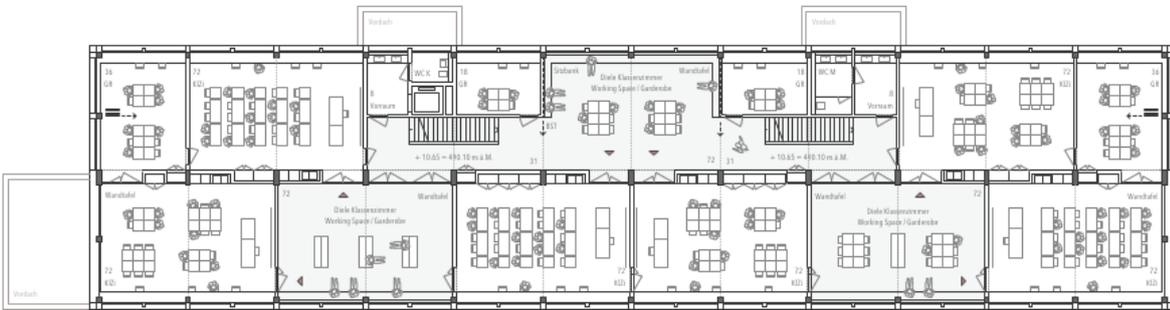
Neubau Sekundarschule, Grundriss 3. Obergeschoss
